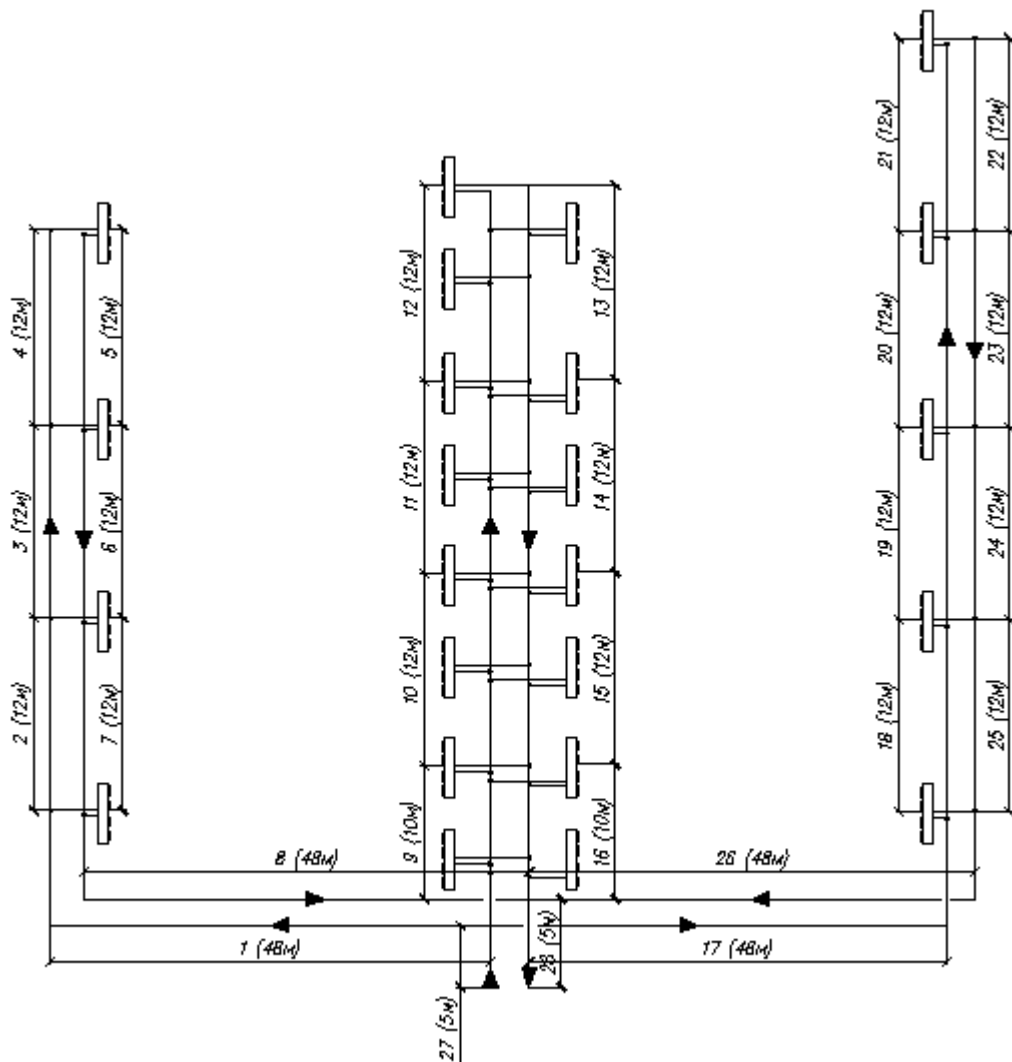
Розрахункова схема трубопроводів для пропіленгліколю
